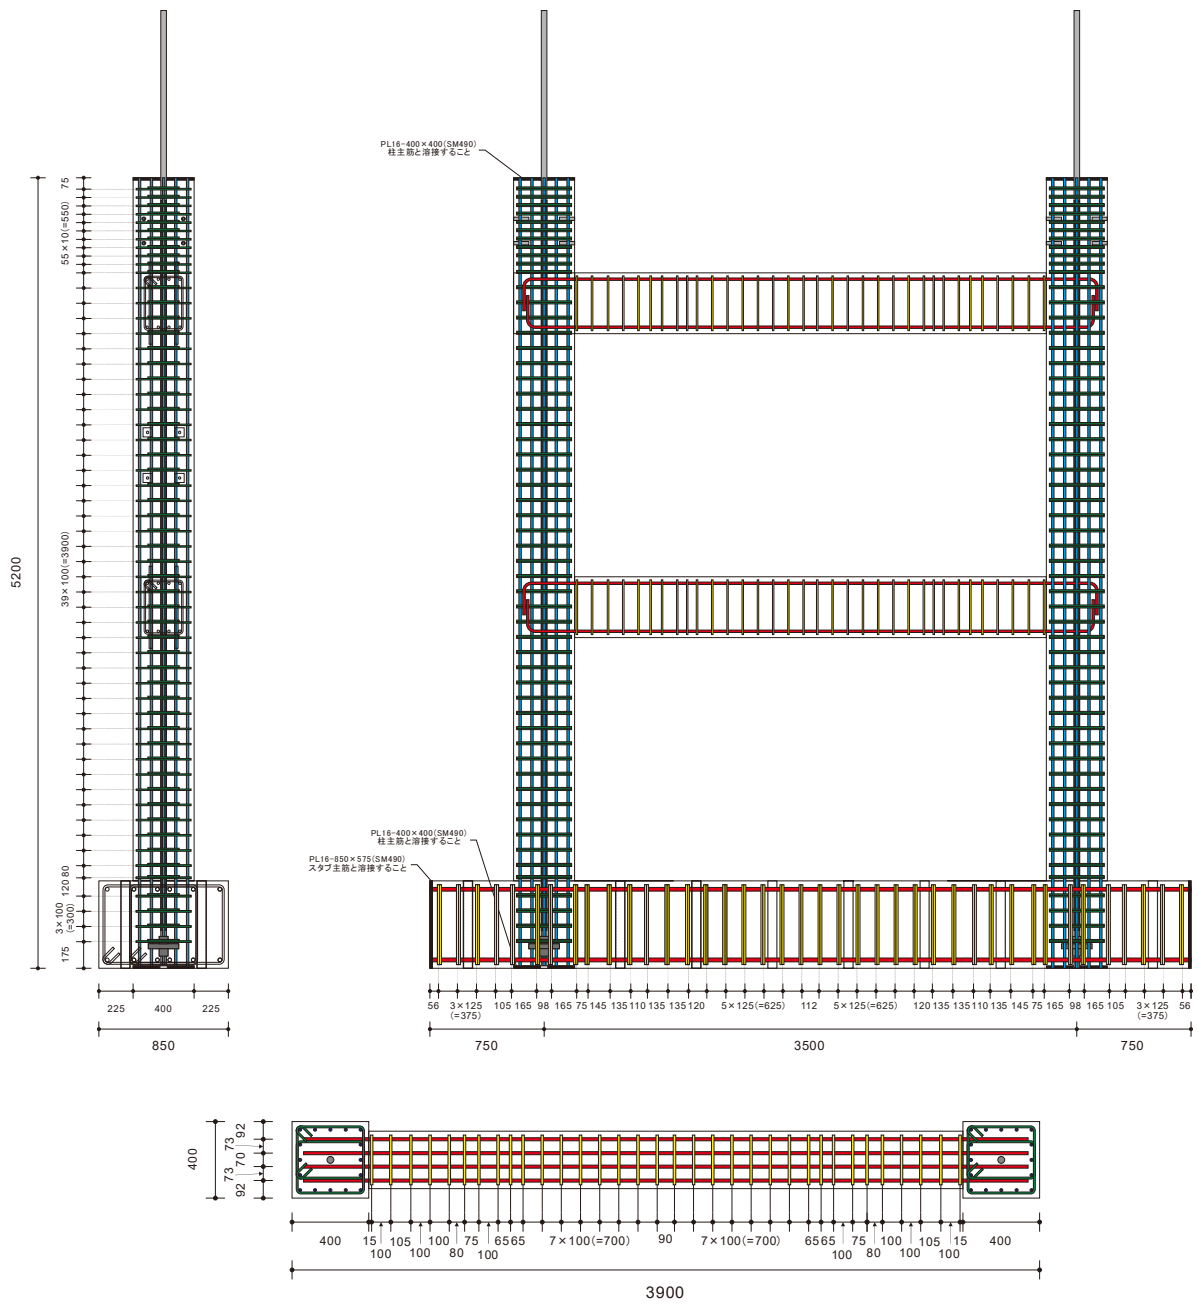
試験体 C の RC 部分の配筋図 (単位:mm)
